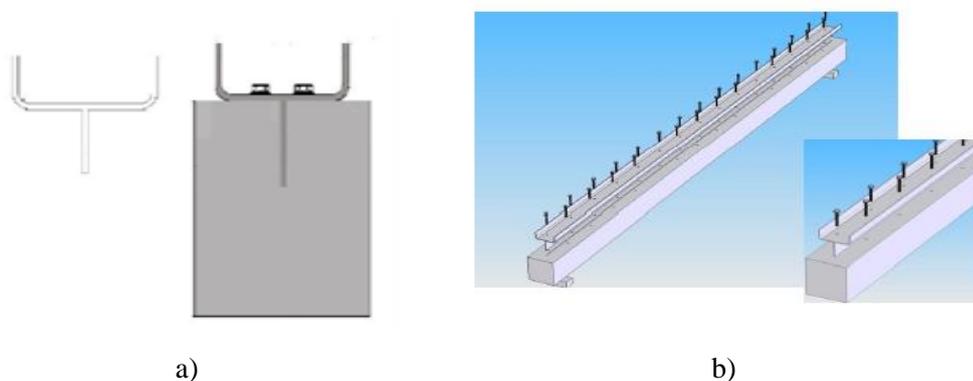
a) Reforço de viga através da colocação de chapa vertical soldada a perfil UNP;
